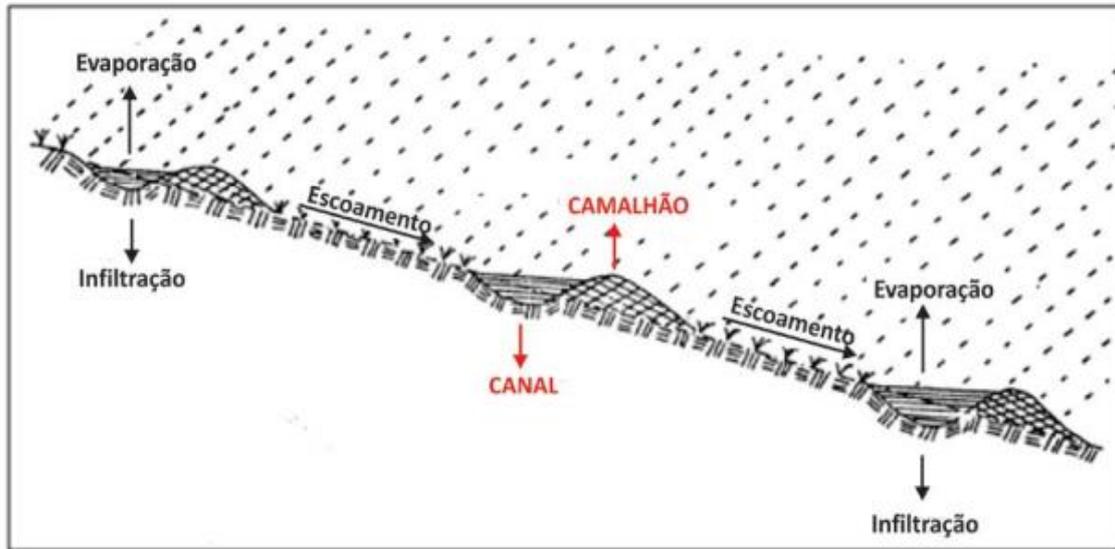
Visão esquemática do terraceamento indicando o sectionamento da rampa com a construção de terraços.
